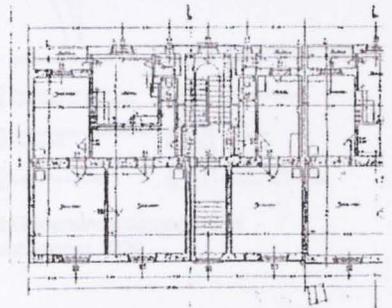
Grundriss Schönaugürtel 58-62
